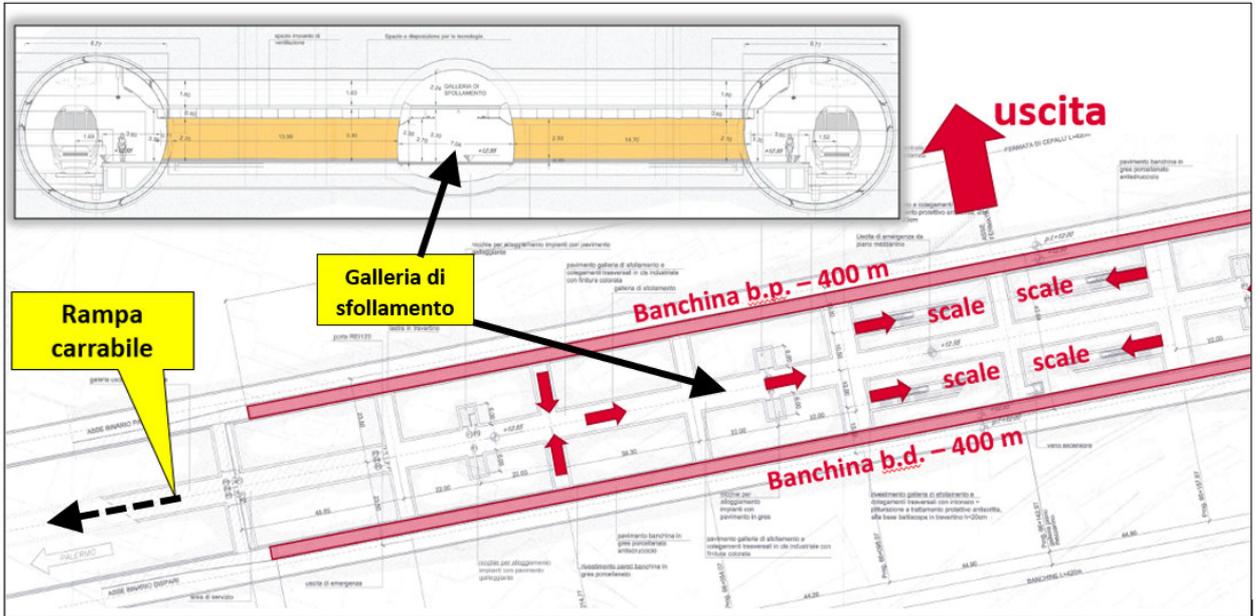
Fermata Cefalù – pianta e sezione piano banchine
